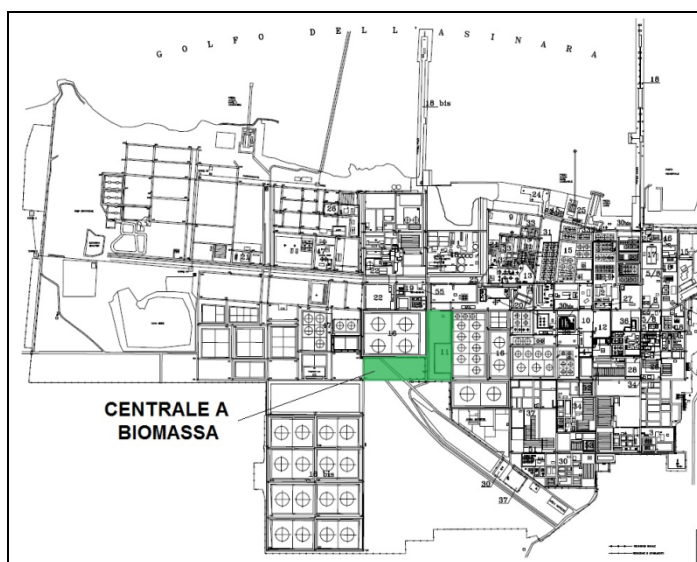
Posizionamento dell'impianto sulla planimetria generale di stabilimento
